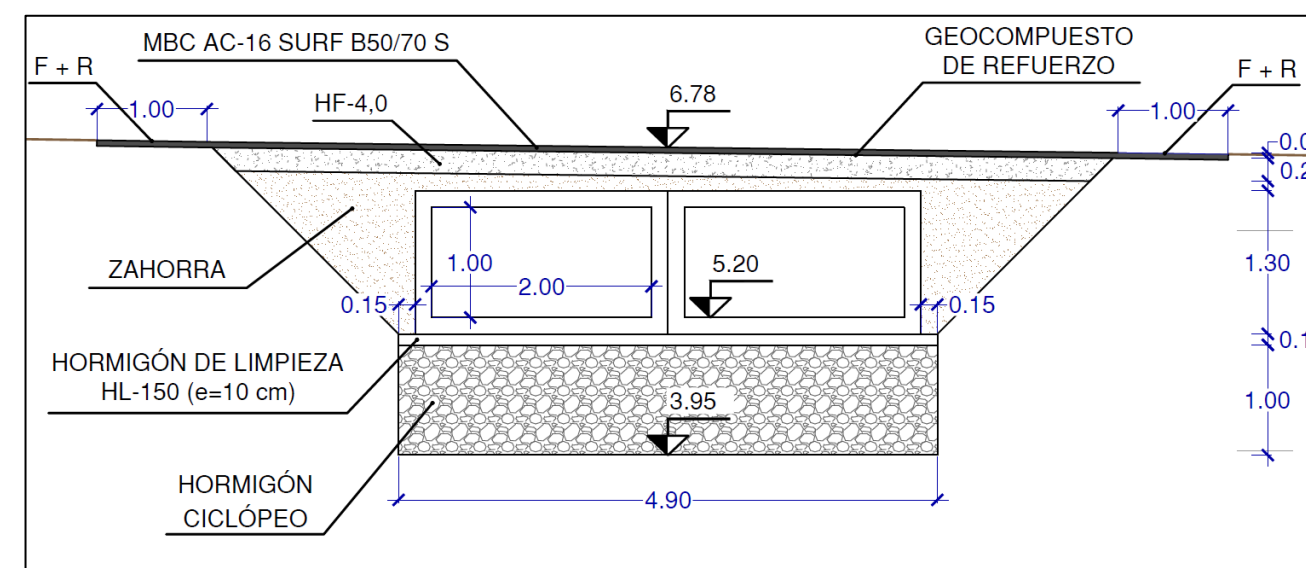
Alzado acotado de los dos marcos de drenaje transversal en el Rego de Brión (P.K. 63+735).
